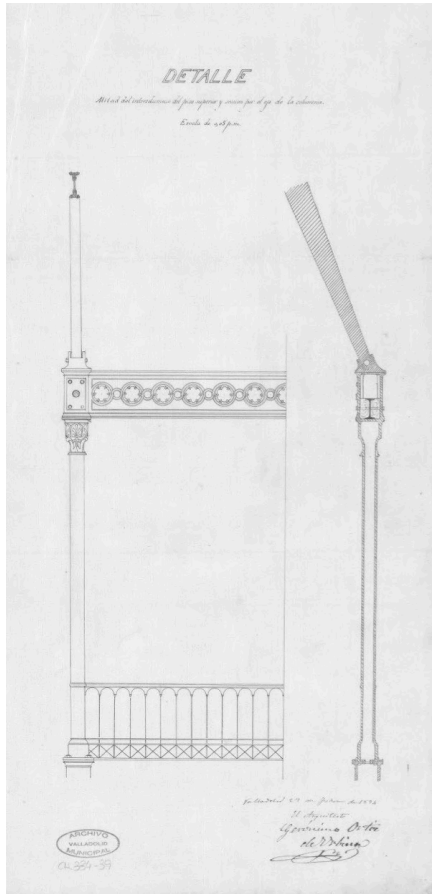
Detalle de las columnas y las gradas de forja y del arranque de la estructura de la cubierta. Fuente: AMVA Chancillería. Caja 334
